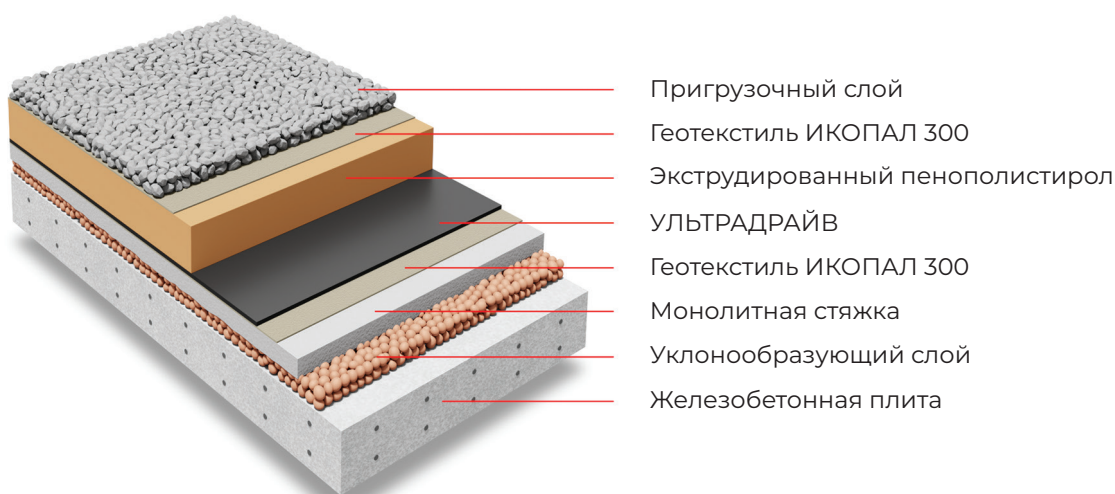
Вариант инверсионной неэксплуатируемой кровли с однослойным кровельным ковром
